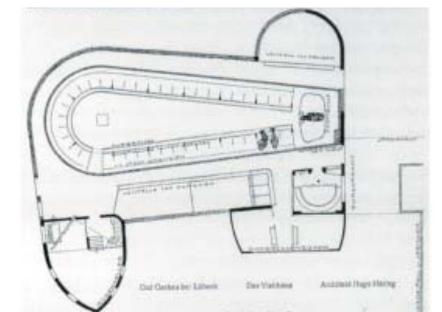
Planta del establo. Fuente: SCHIRREN, 2001. 323
